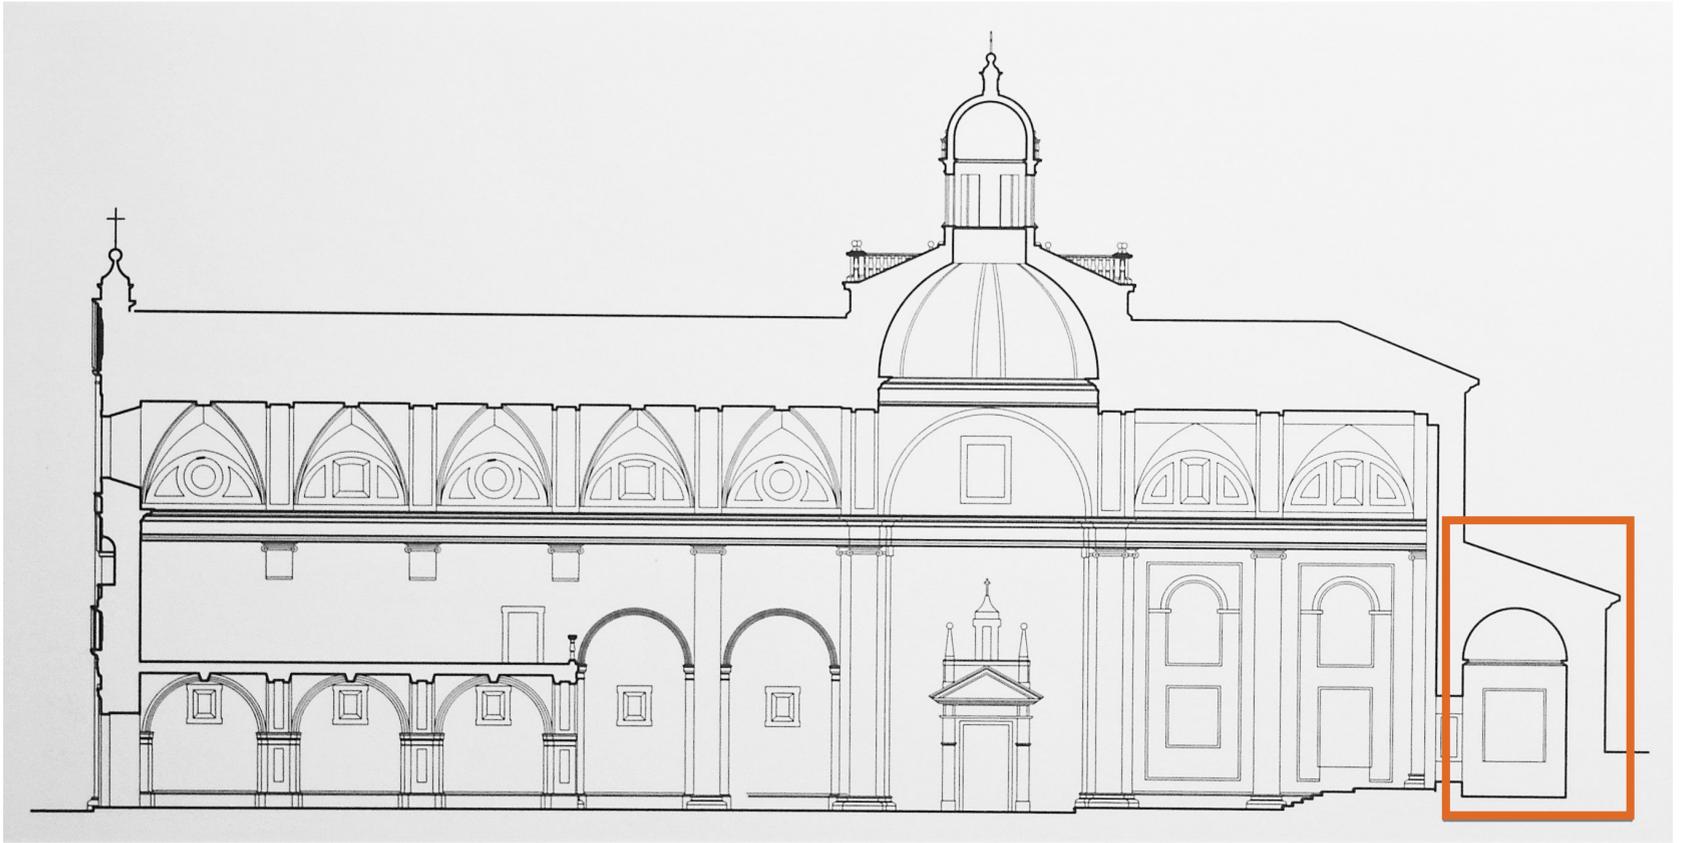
Santa Maria De Oia, planta, acceso.
